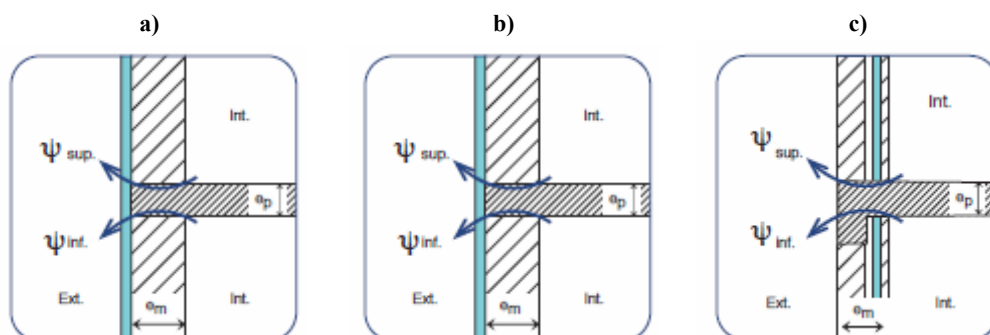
Ligação da fachada com pavimentos térreos
